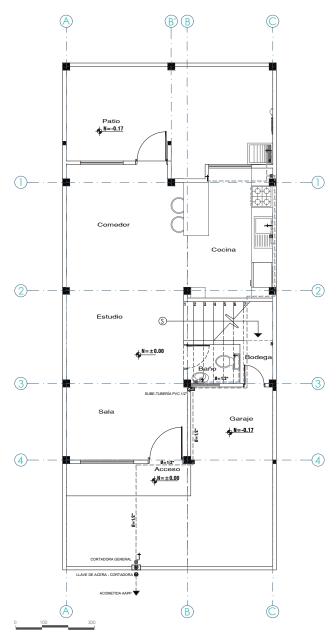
Instalaciones Agua Potable planta baja propuesta Nota: Elaborado por el autor
